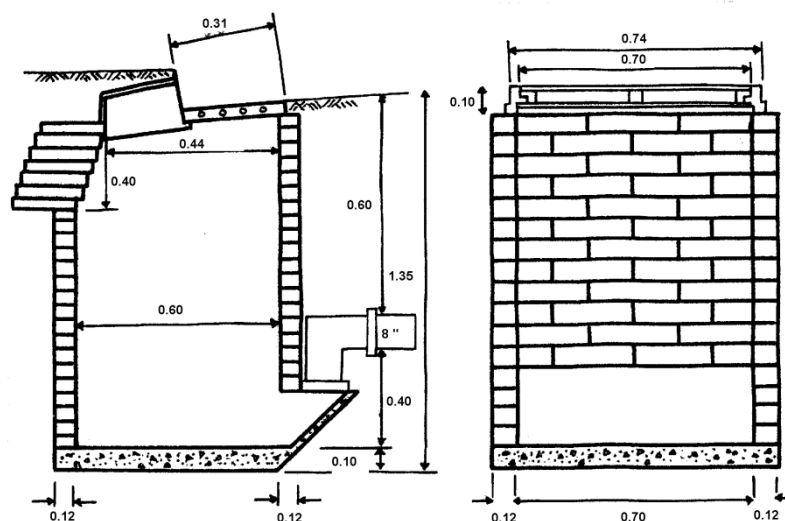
Tragante con sello hidráulico para alcantarillado combinado. Todas las medidas están en metros.
